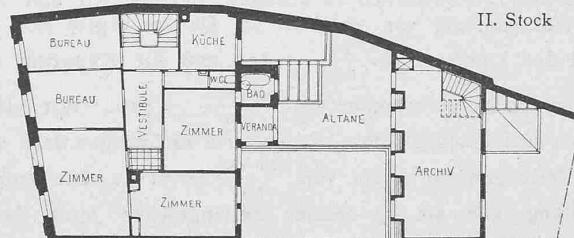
Das Haus «Zum Eichbaum.» — Architekten: La Roche, Stähelin & Cie. in Basel. — Grundrisse. — Maßstab 1:400.
